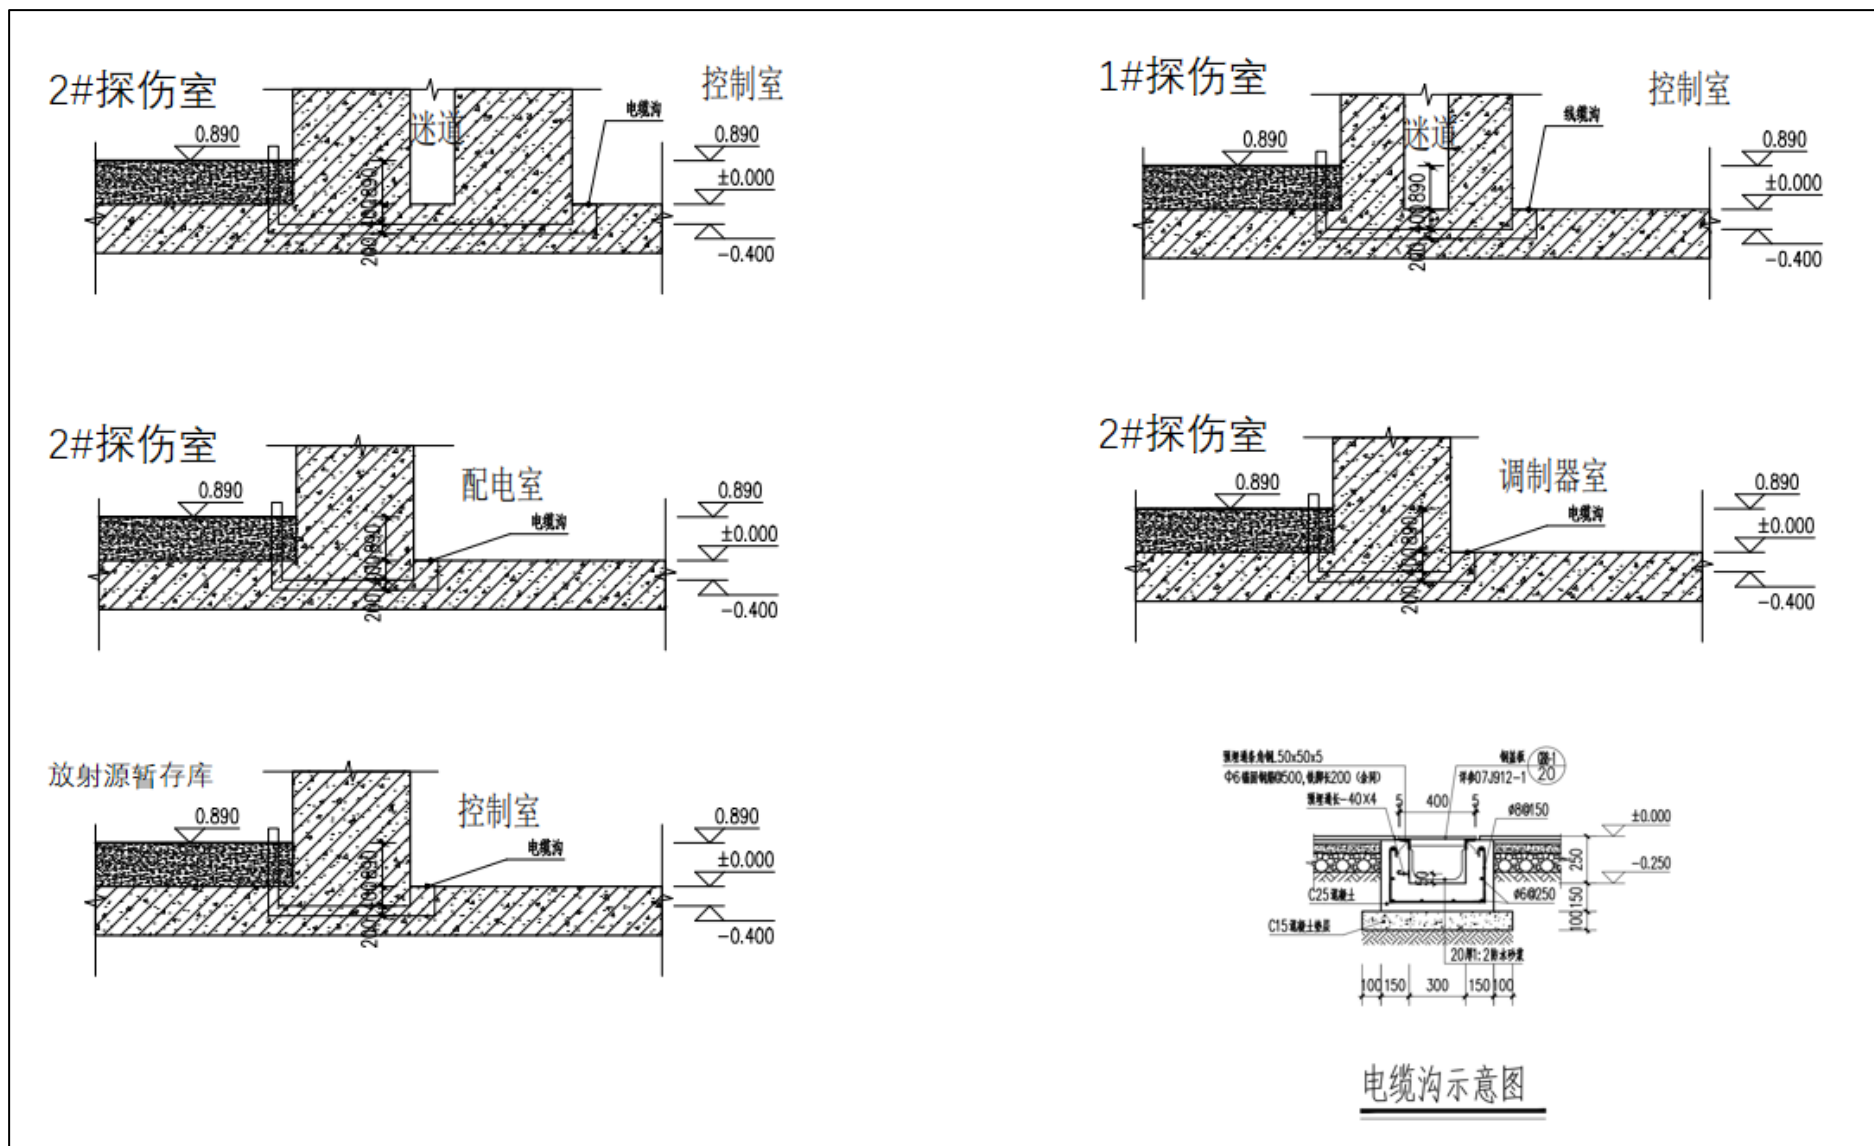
本项目穿墙管道剖面图 (单位: mm)
